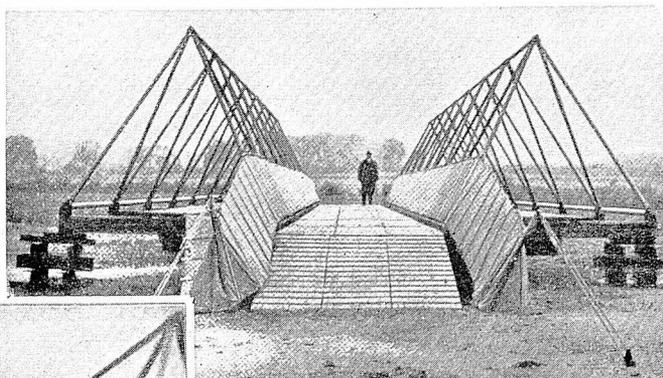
<sup>a</sup> Puente gemelo para tráfico ligero
